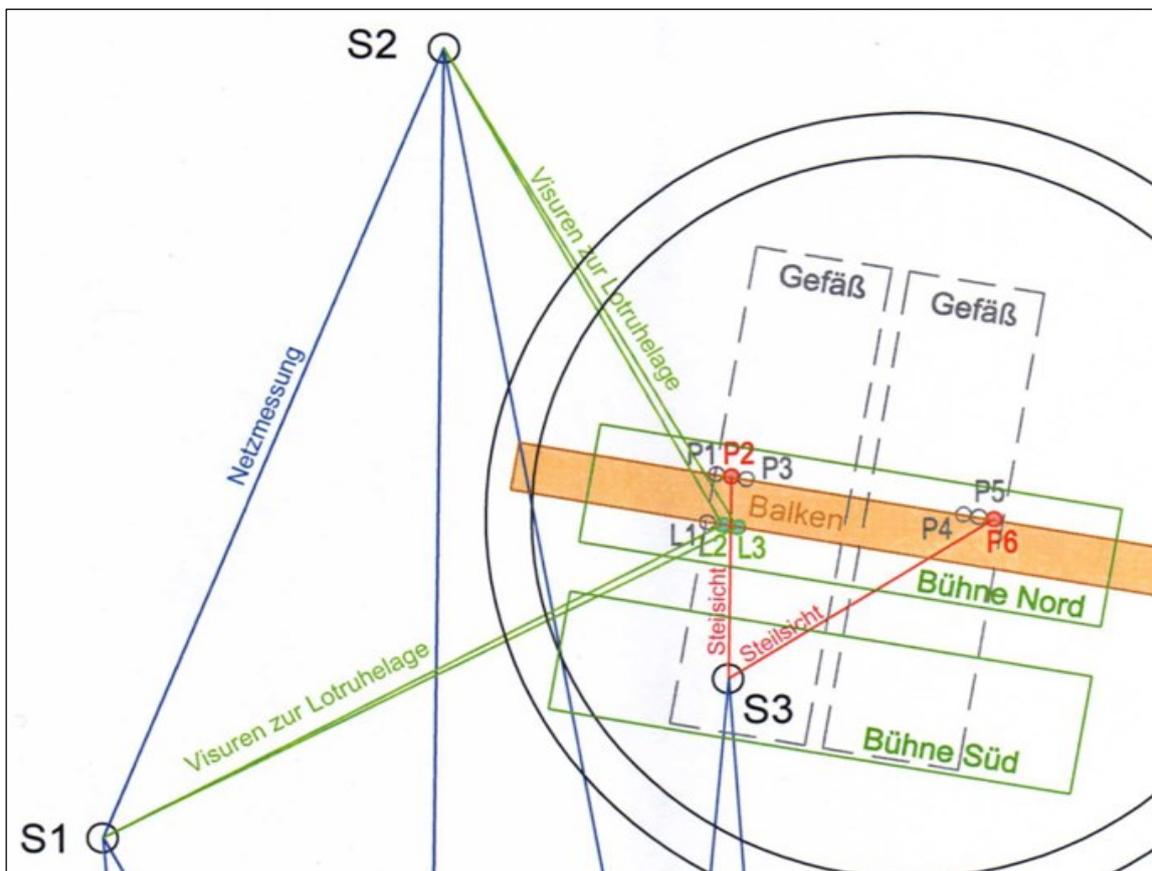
Schematischer Grundriss von Füllort, Schacht und übermäßigem Messbalken.
